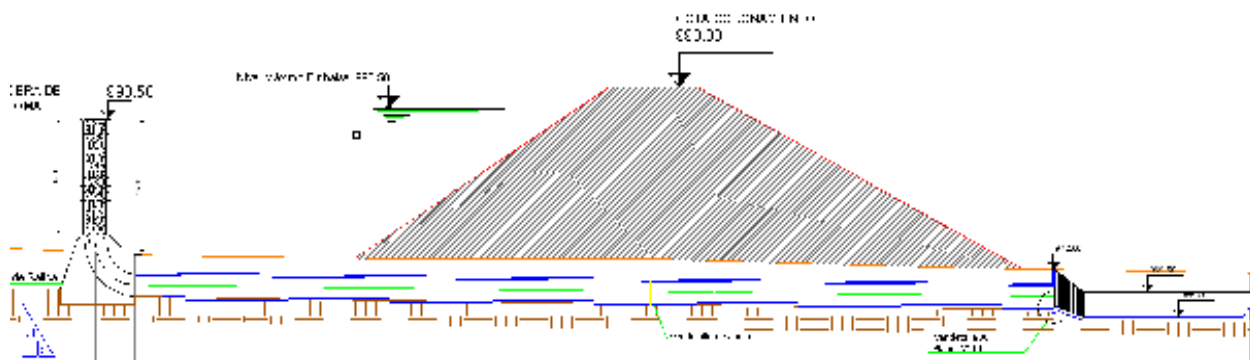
Corte Transversal de la Presa Chacras de Coria y la obra de descarga
